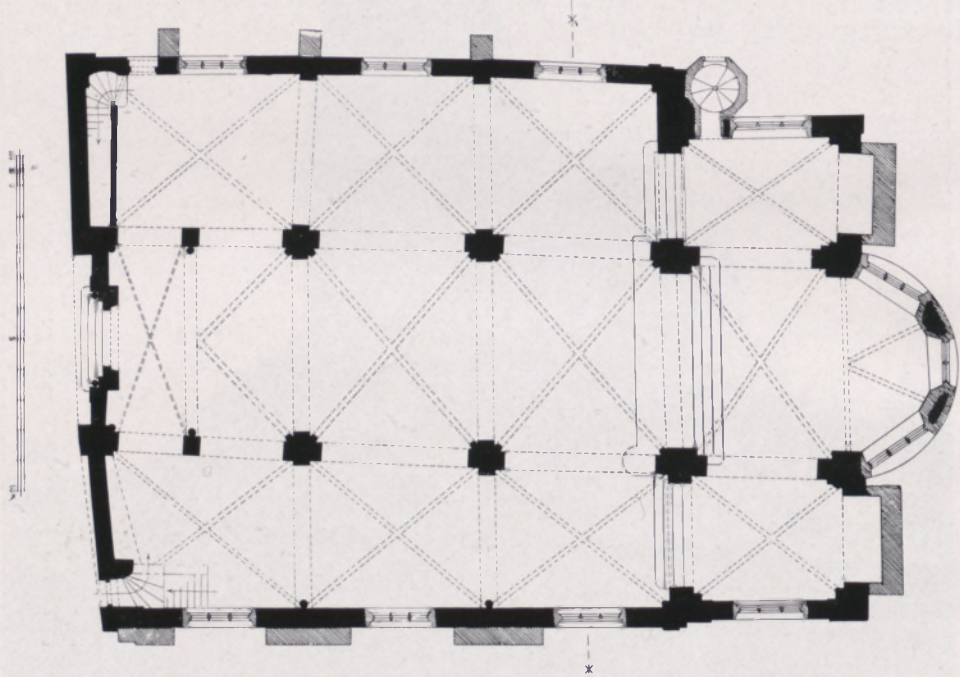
St.-Maria-Lyskirchen. Grundriss.
